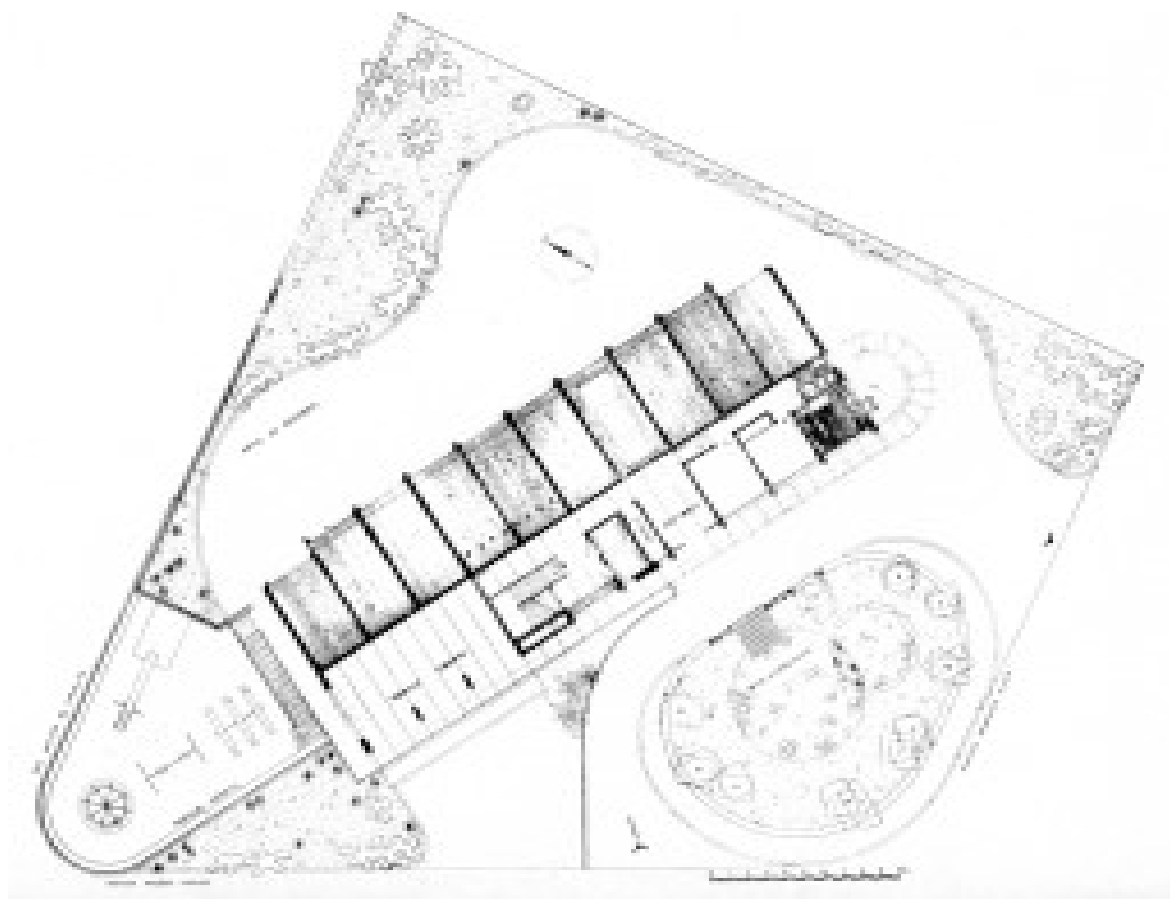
Planta do pavimento térreo: Edifício Brasil Portugal.
